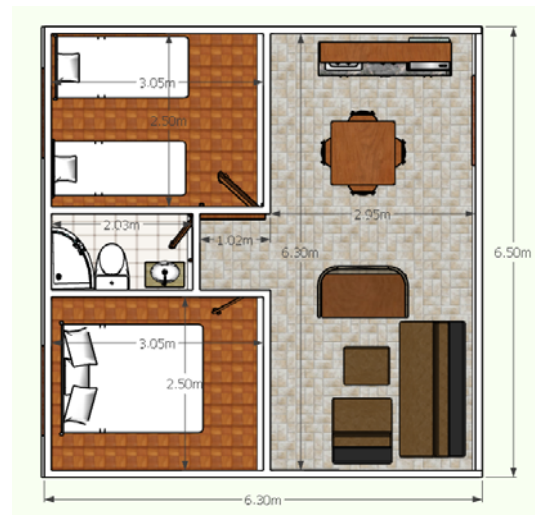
Vista de Planta de VUF 04: 42.21 m².
